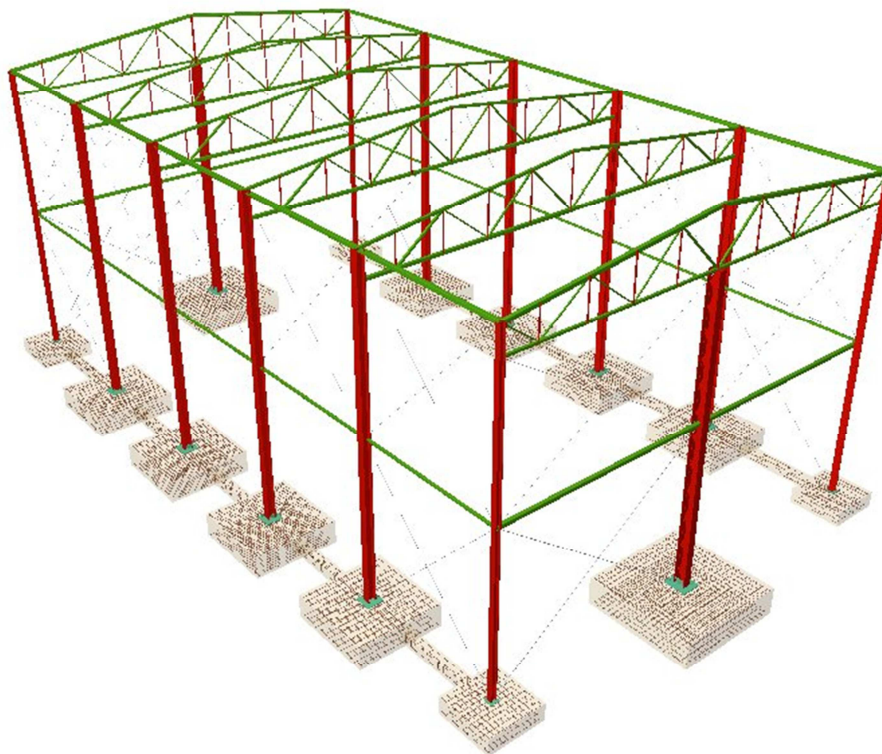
Vista 3D Tipología 2.1 Pórtico de celosía con tirantes en fachada
